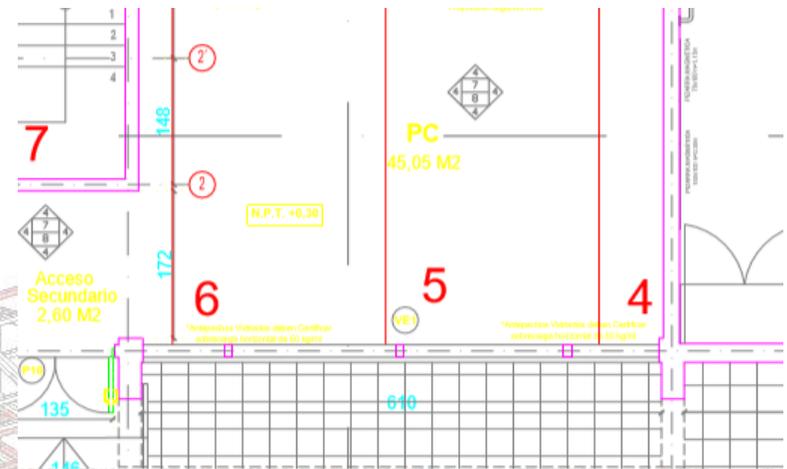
Estado inicial de vanos de fachada OESTE fragmentada. Elaboración propia
